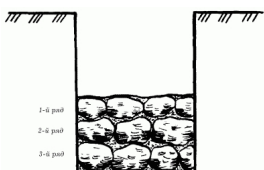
Кладка бутового камня враспор со стенками траншеи.
